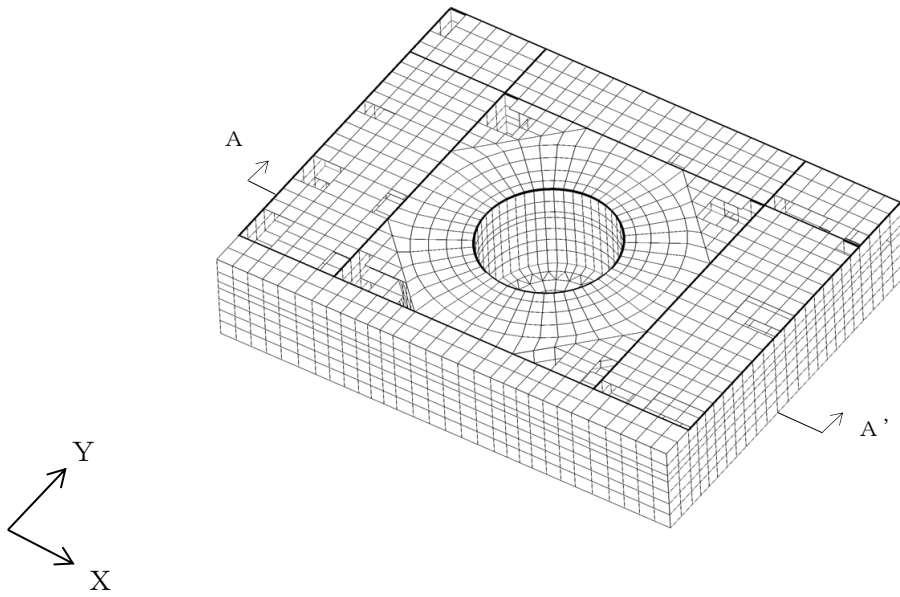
(1) 原子炉建物基礎スラブの概略断面図
